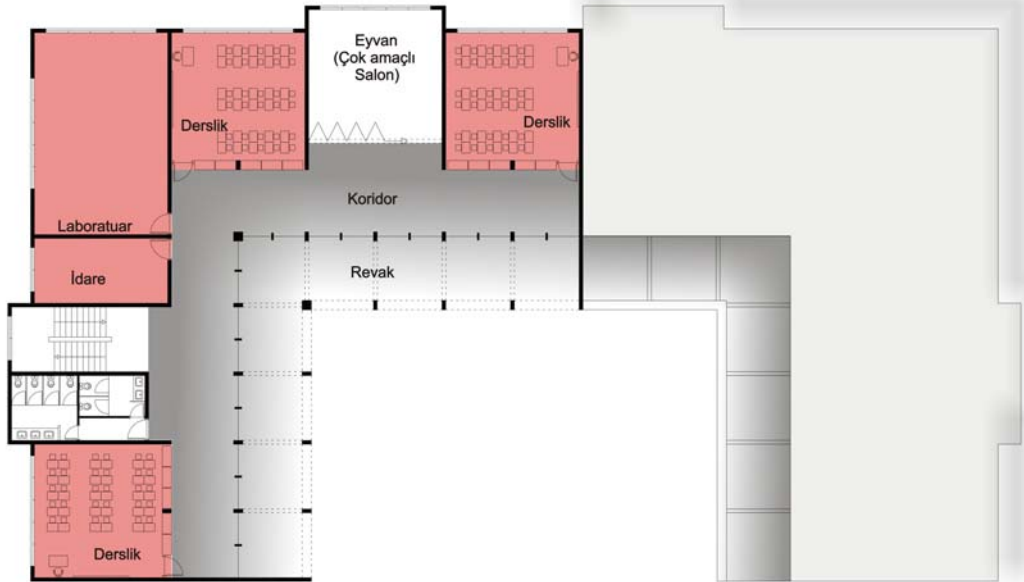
Altı derslikli ilköğretim okulu plan şeması
